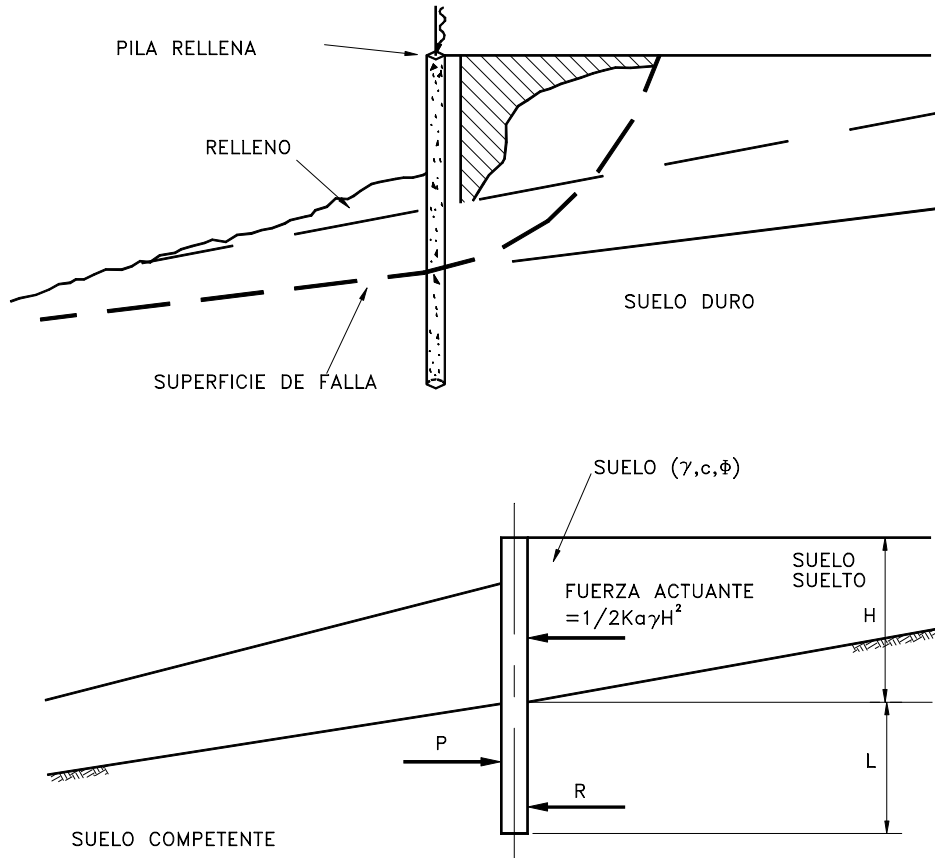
Esquema del planteamiento de una pila como muro de contención.
